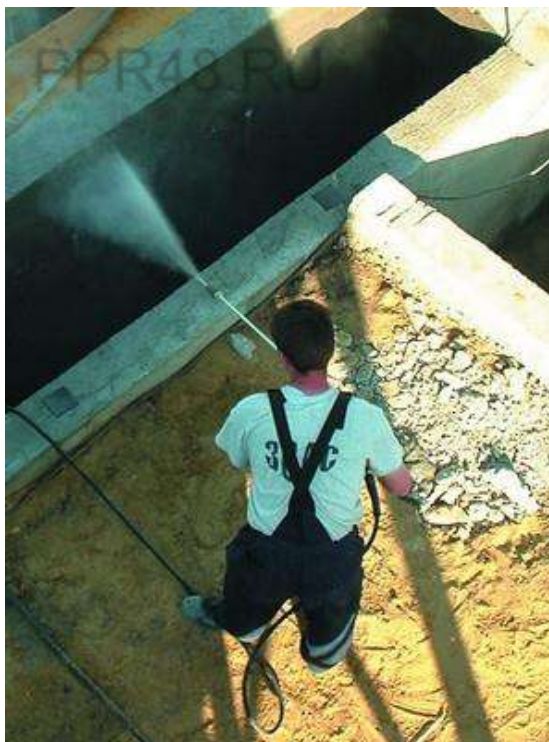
Подготовка поверхности фундамента к нанесению гидроизоляционного состава.
